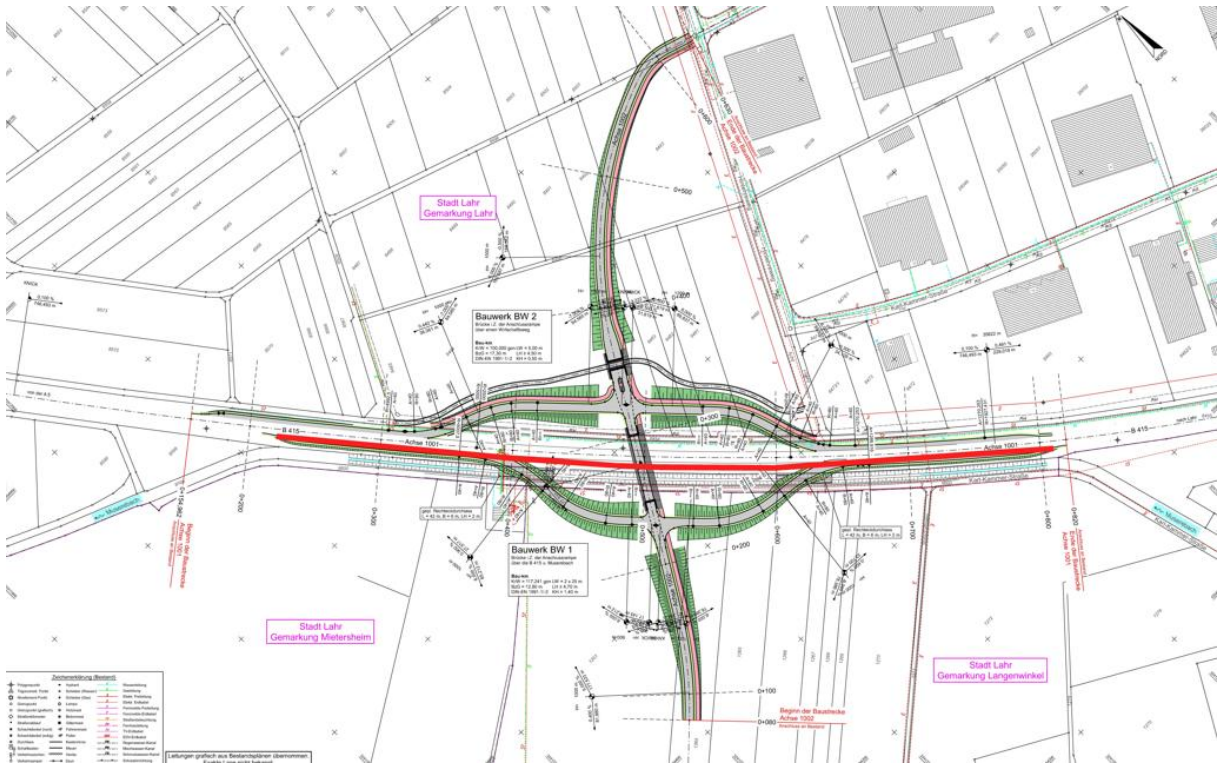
Teilplanfreier Knotenpunkt mit paralleler Rampenführung
